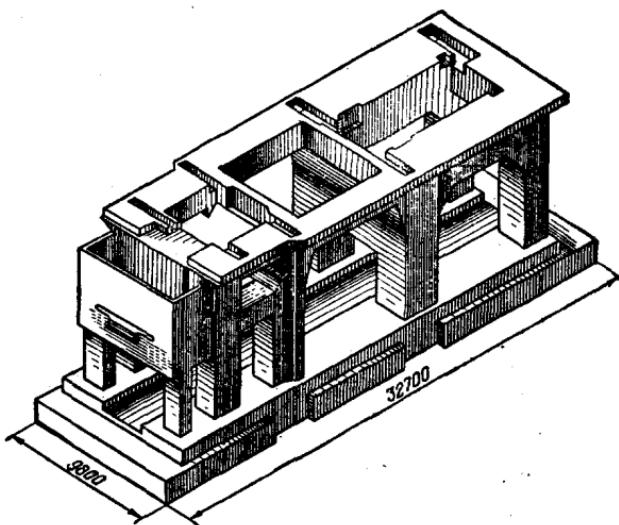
容量为15万千瓦汽轮机组的现浇钢筋混凝土基础外形图
